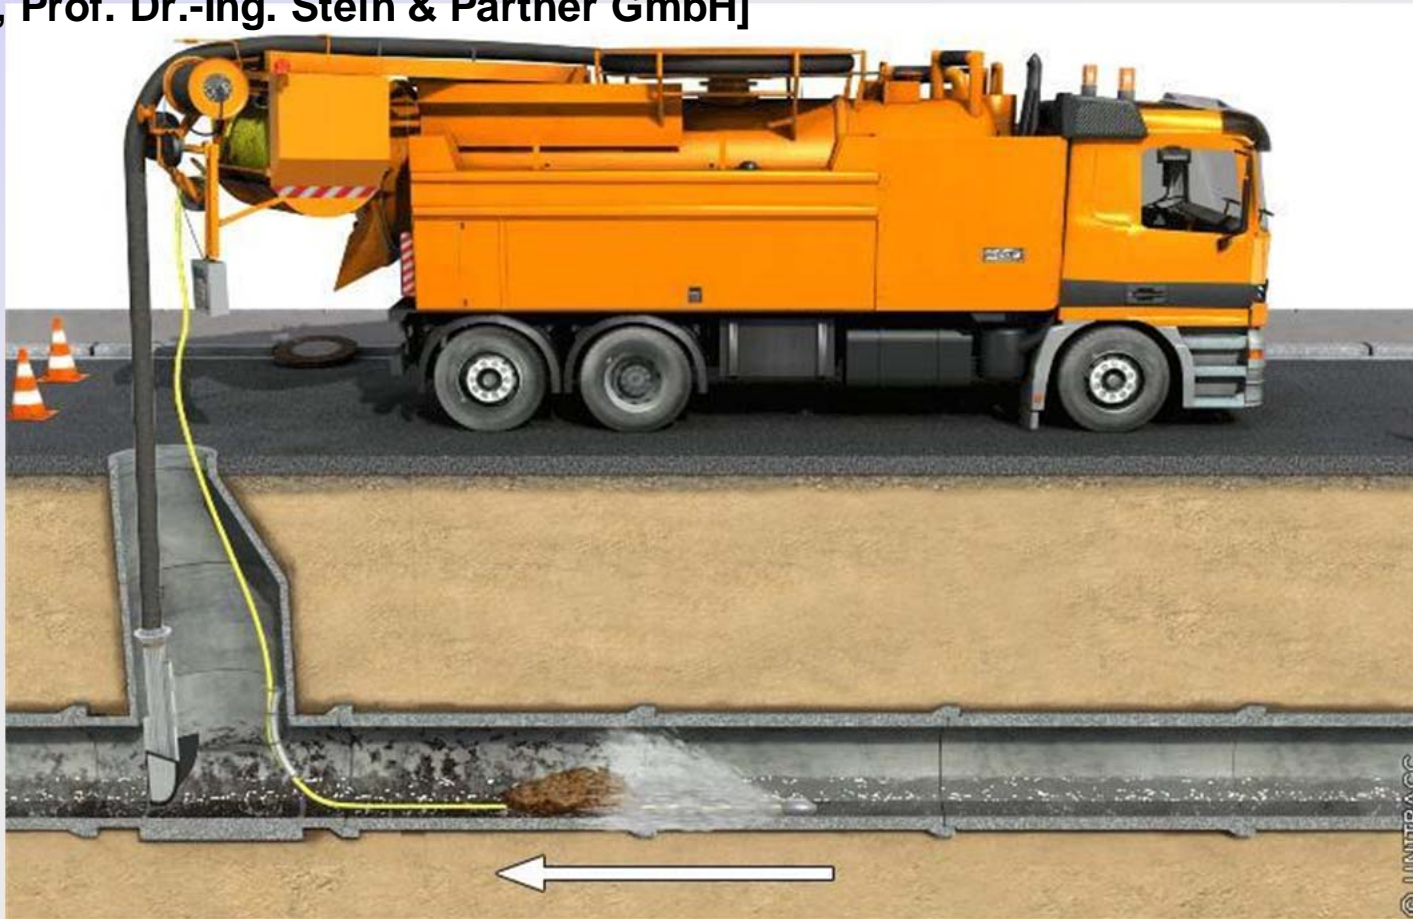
Prof. Dr.-Ing. Stein & Partner GmbH]
